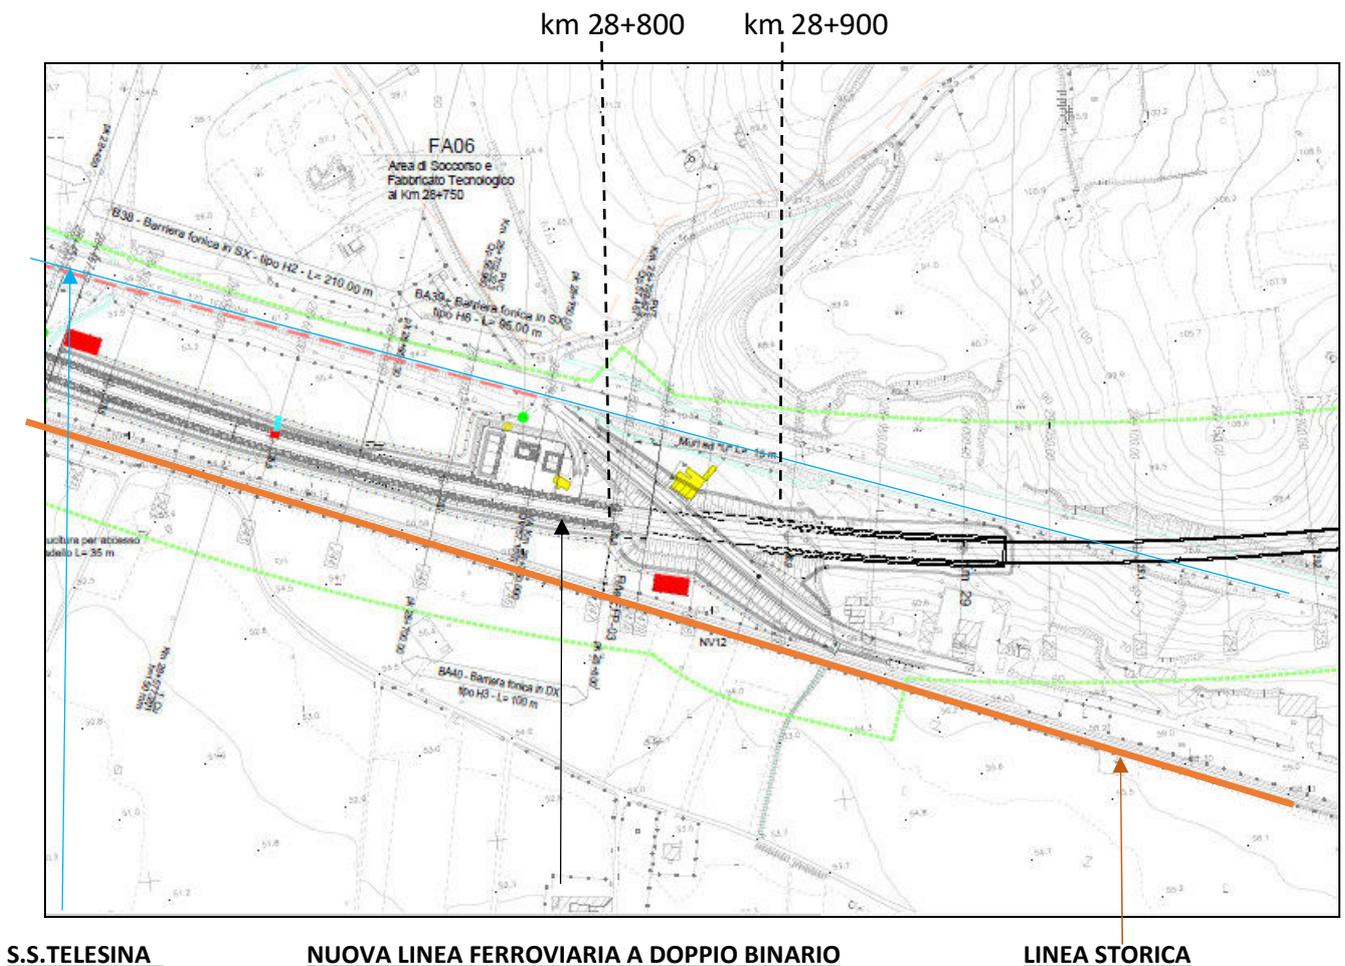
Stralcio planimetrico del tratto progettuale GA03
